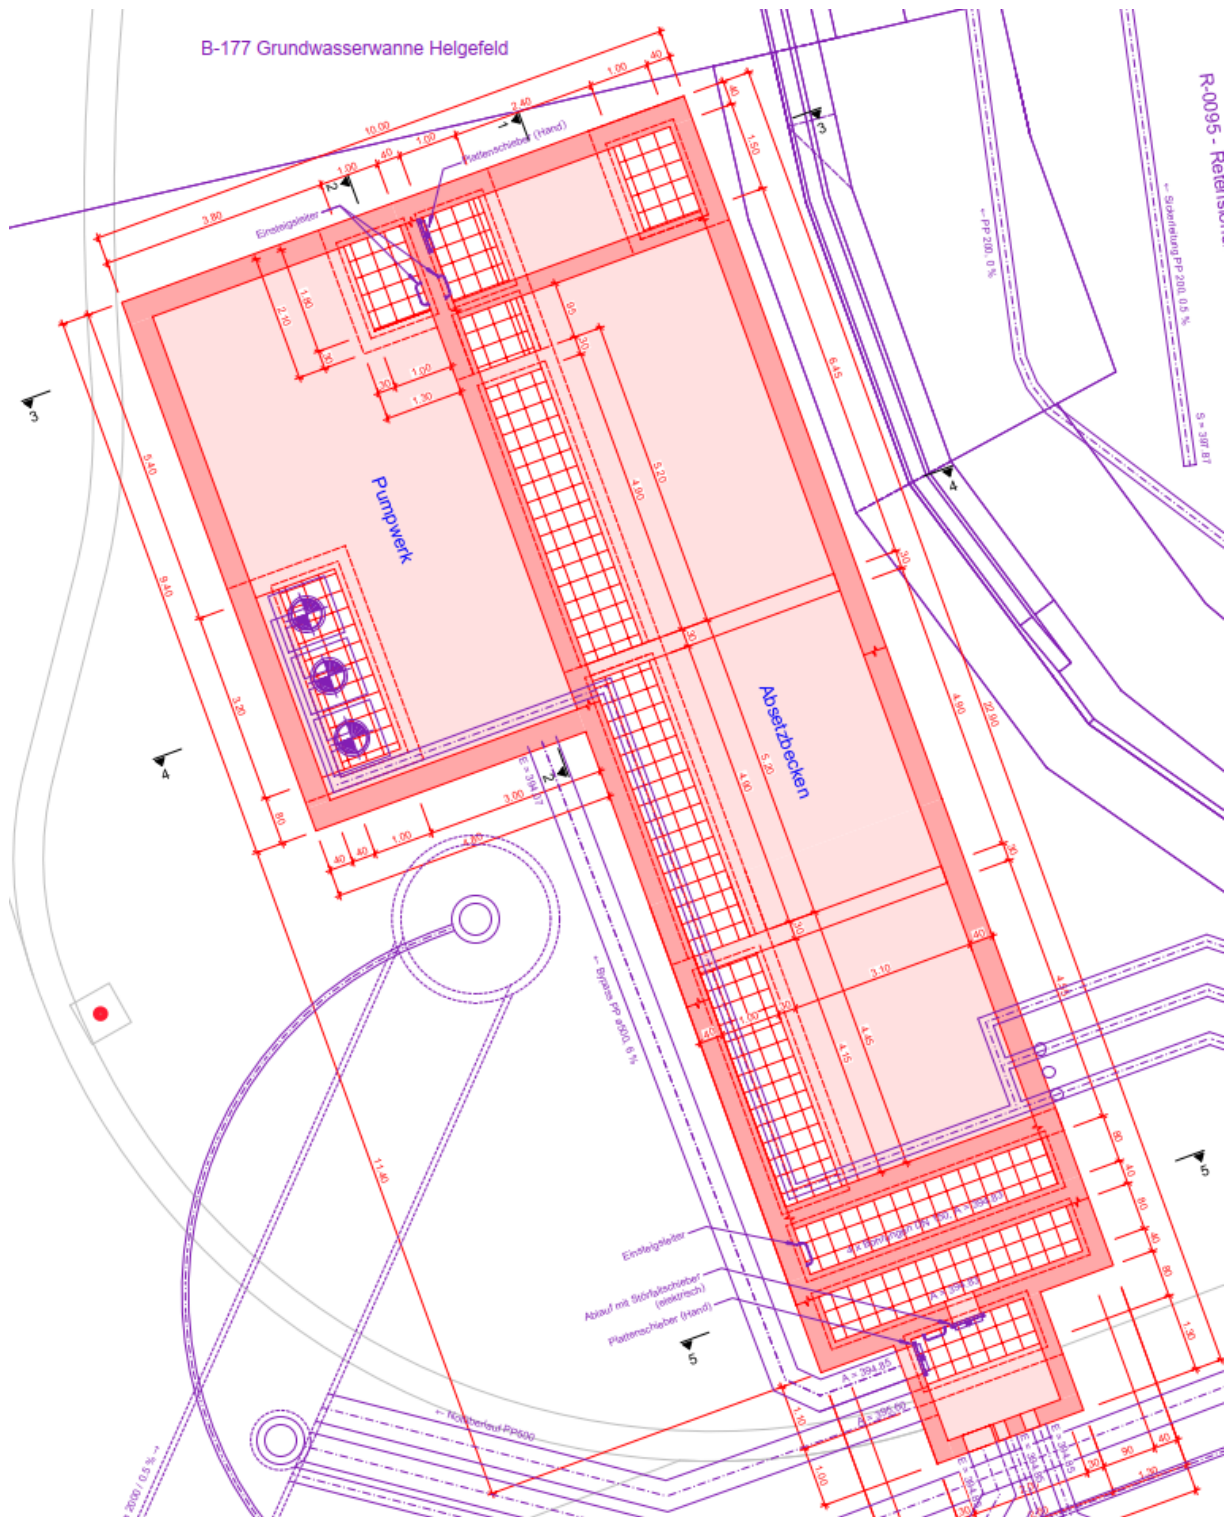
Grundriss Deckenuntersicht Absetzbecken
